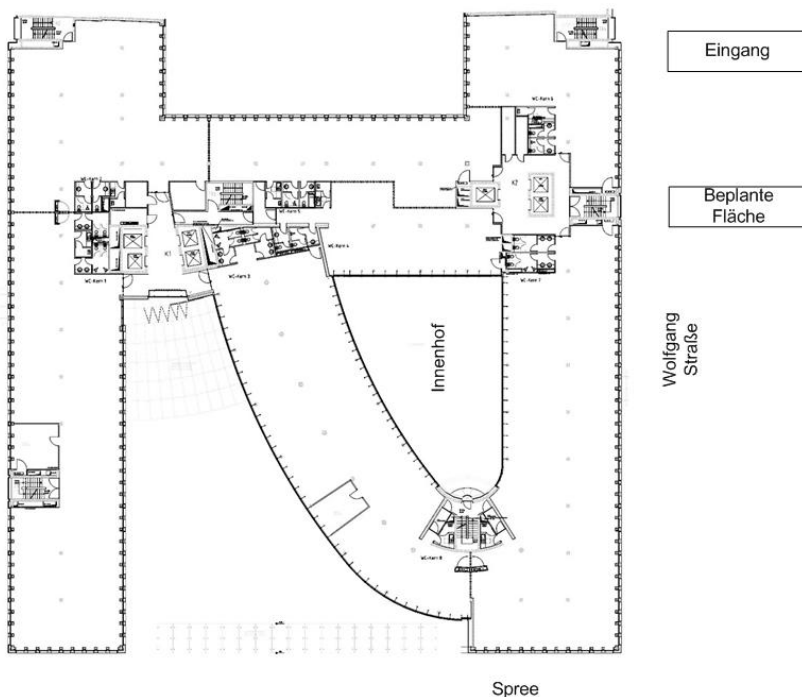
Gebäudegrundriss Spreepalais und Orientierung
